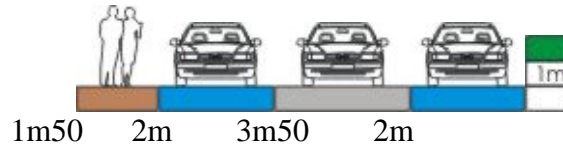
profil de la voirie locale proposée le long du quai de Willebroeck
